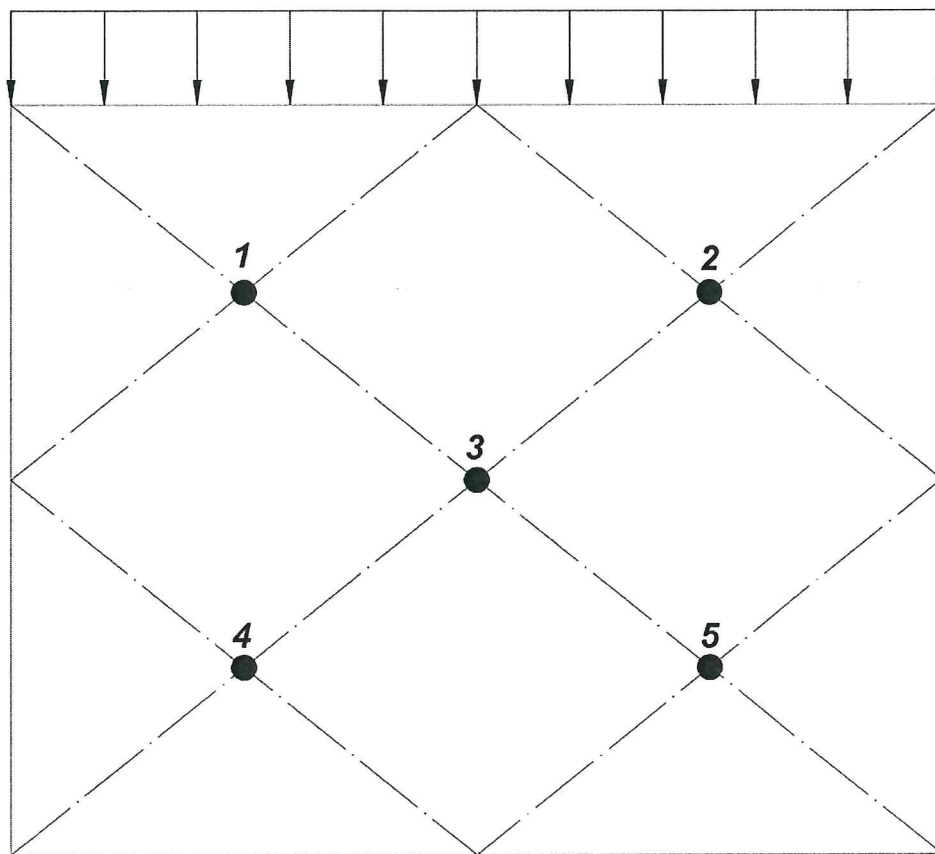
Схема расстановки термопар на необогреваемой поверхности образца и схема нагружения образца.
